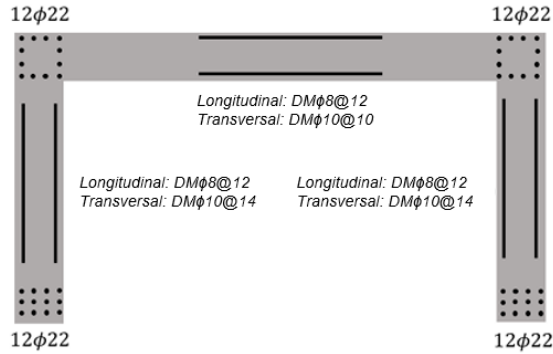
Refuerzo Muro C superior MC2.(Cofré, 2020)
